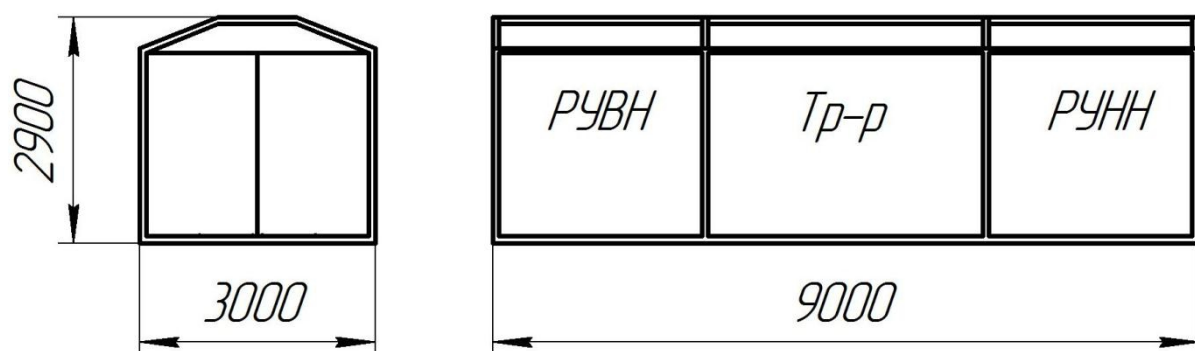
Схематичный общий вид КТПН-БТКК-630...2500-10(6)/0,4-УХЛ1
